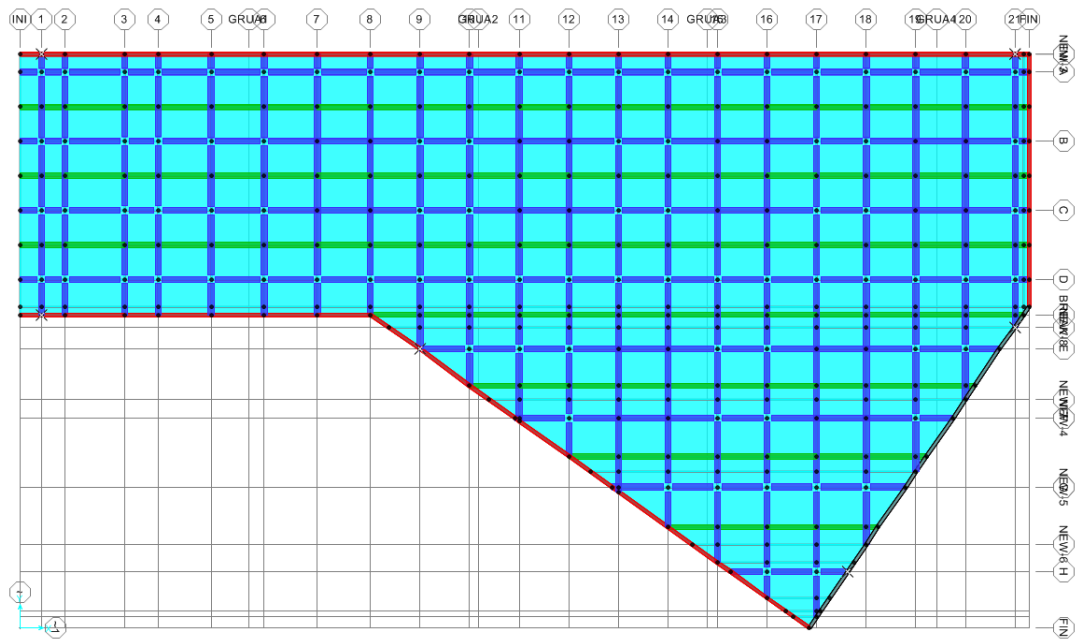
Vista en planta de modelación, paralelo a plano X-Y'.
